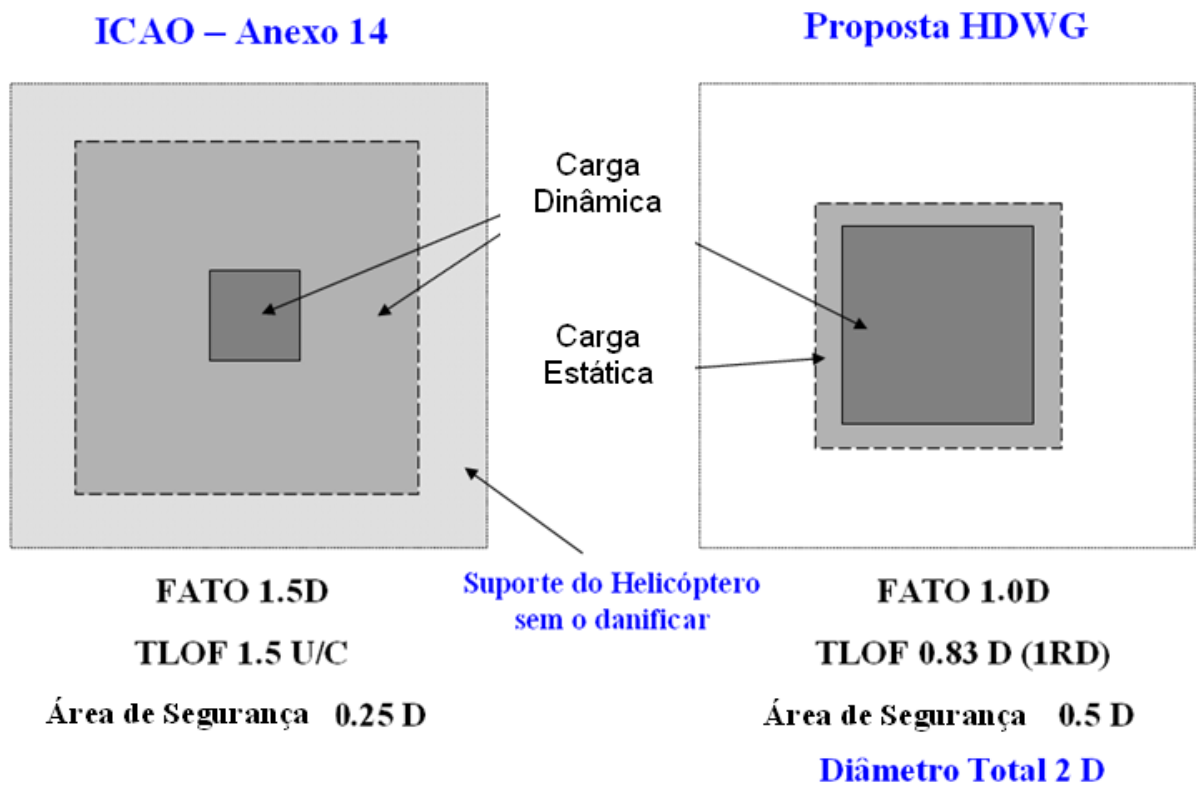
Dimensões da zona de aterragem para PC2 em heliportos de superfície
